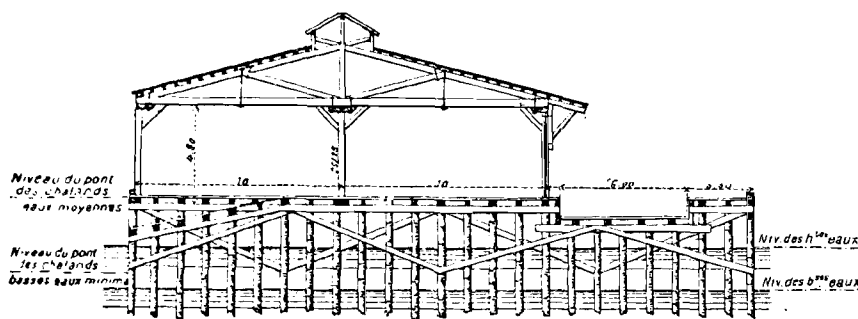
Coupe transversale du hangar G représenté en plan sur la planche CXXIX.
